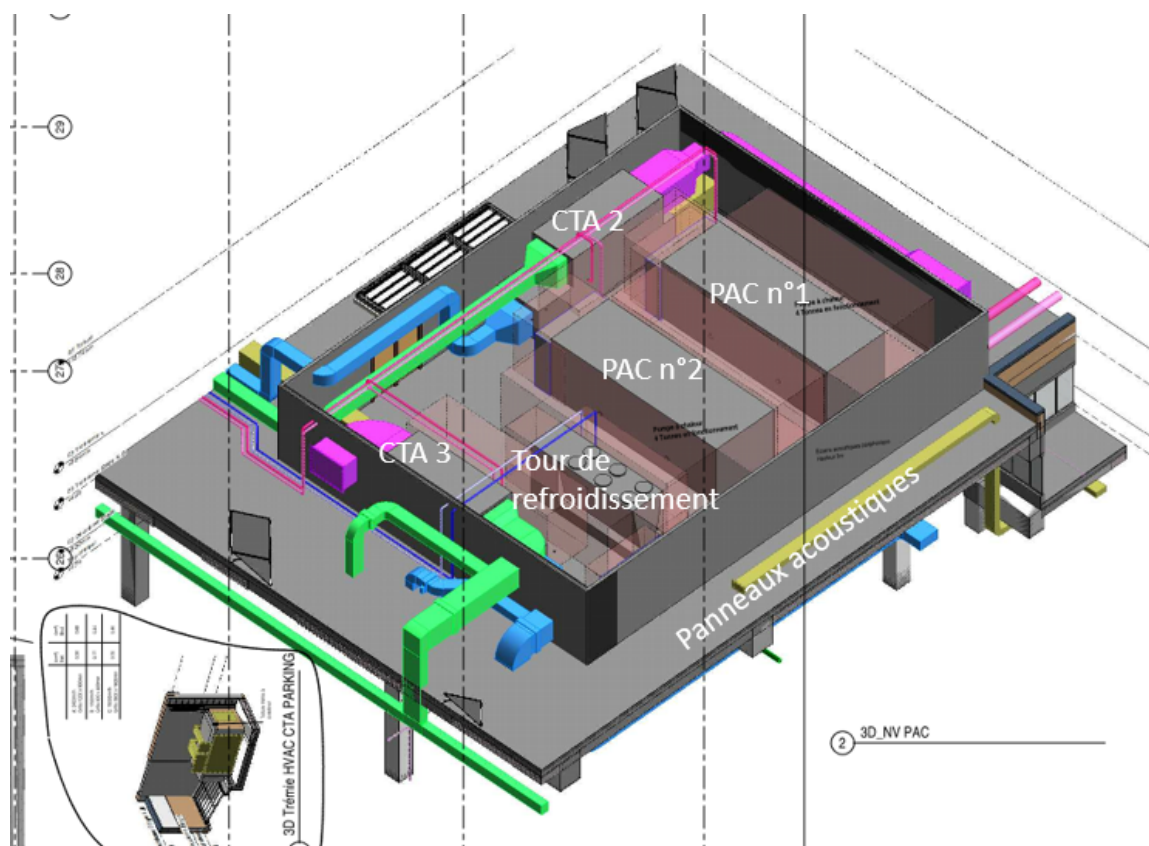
Représentation 3D des panneaux acoustique autour des techniques – Extension dépôt (source : TPF Engineering)
